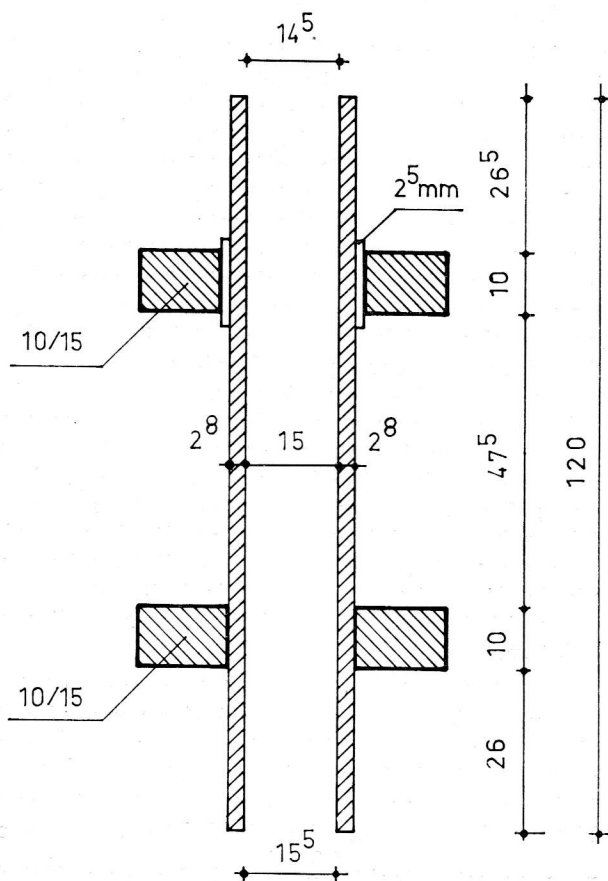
Montažni komadi oplate od blanjanih dasaka ili vodootpornih šperploča
